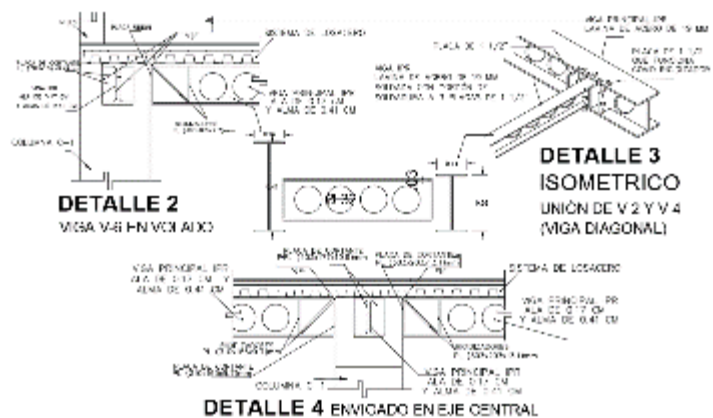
Detalles, dimensiones, y ubicaciones en ejes de vigas alveoladas.
